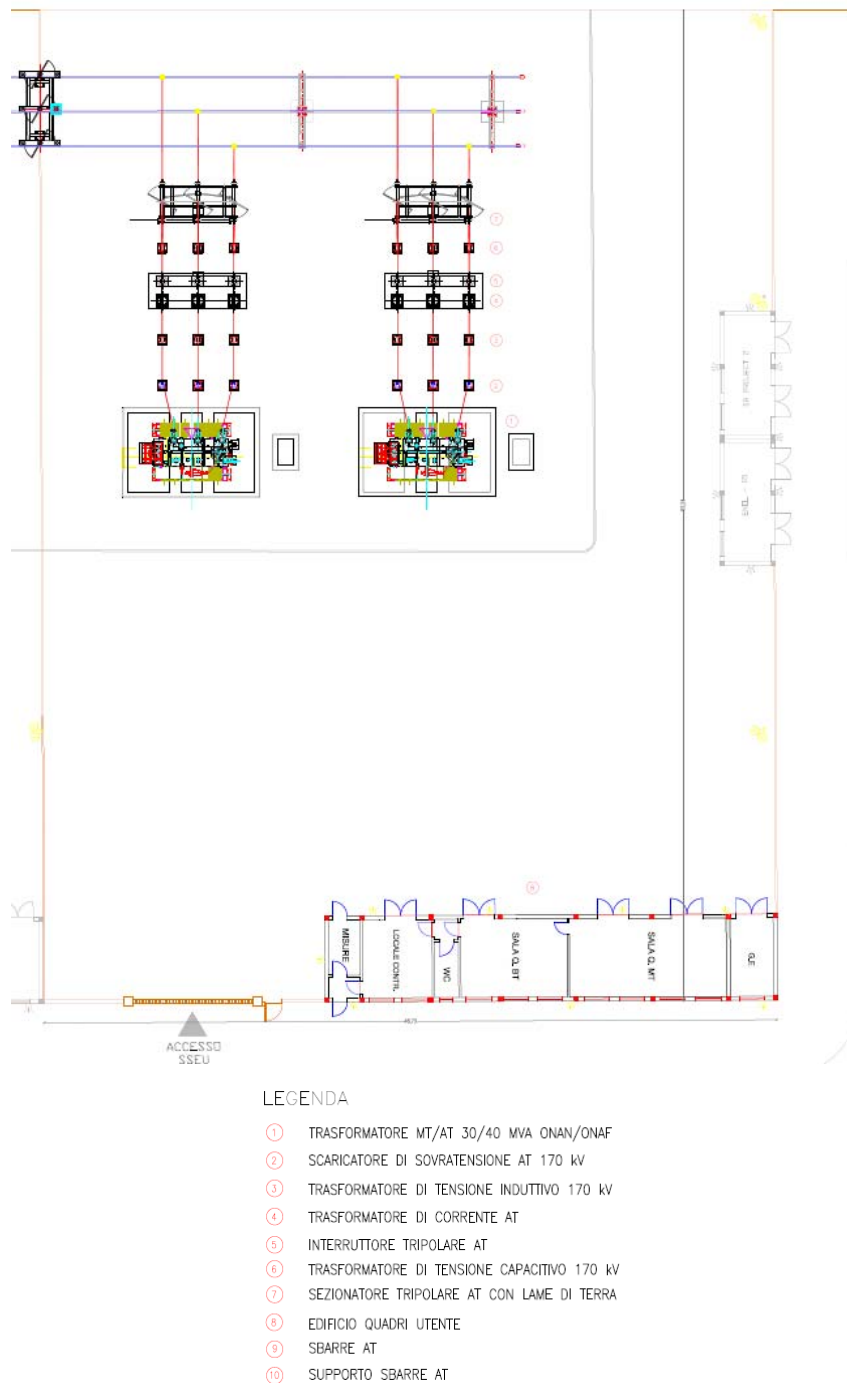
Planimetria Sottostazione Utente SR PROJECT 2
